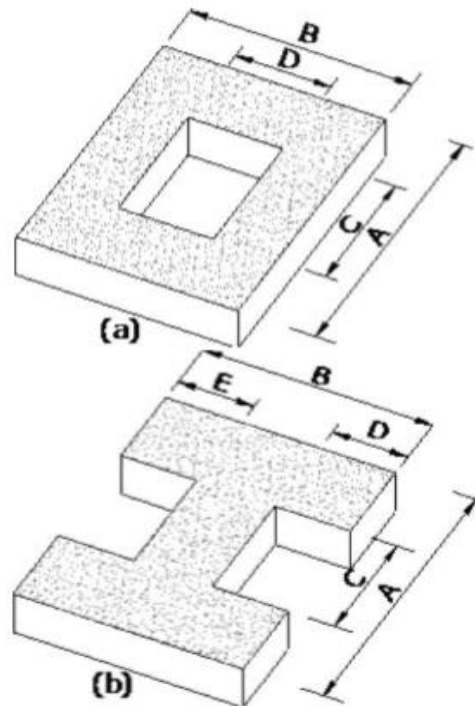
Discontinuidades en el sistema de piso (Irregularidad en Planta Tipo 3)
